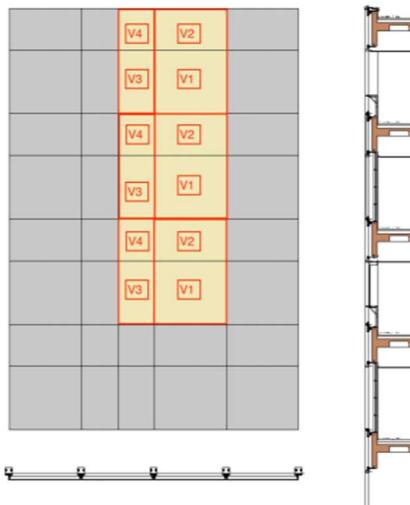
Locais em que houve a remoção dos vidros no trecho 2. Fonte: Relatório Petrucci Consultoria e Engenharia. Plano de desmontagem da fachada cortina (21/12/2017)
